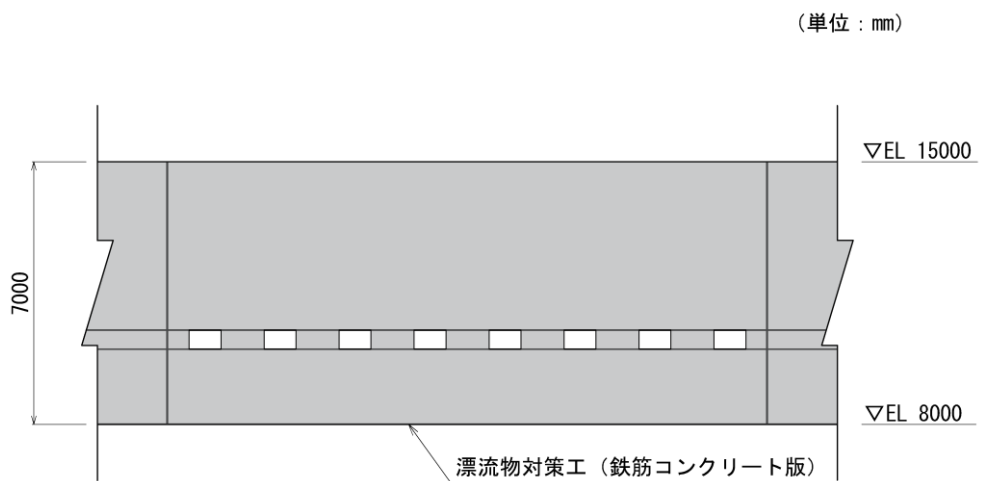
(2) 漂流物対策工 (鉄筋コンクリート版) の構造概要図 (正面図)
